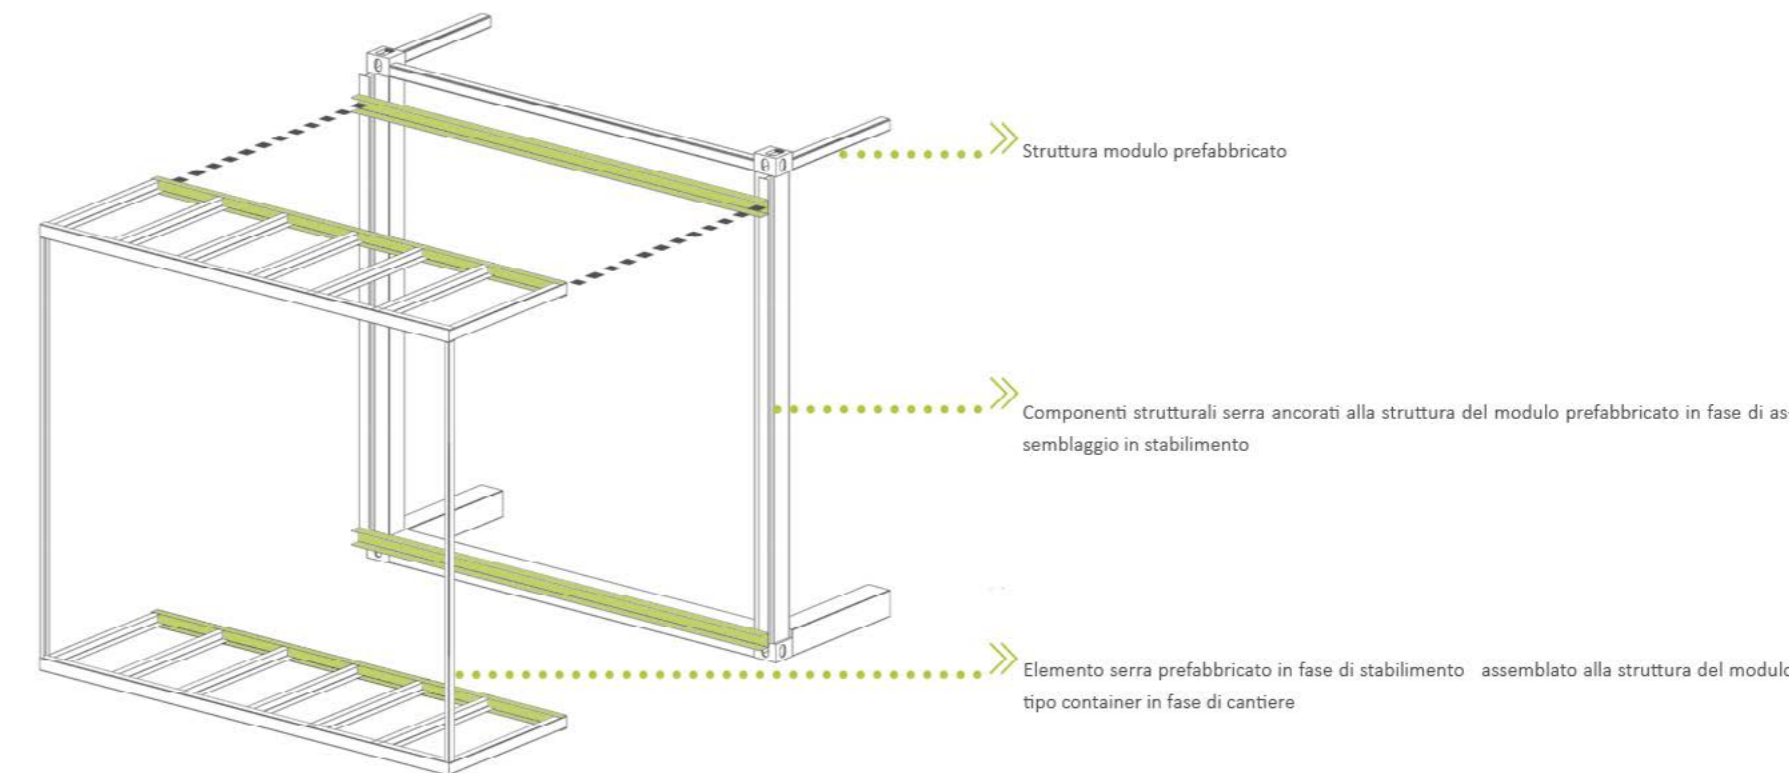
Spaccato assometrico della connessione tra elemento a sbalzo e struttura dei moduli.
